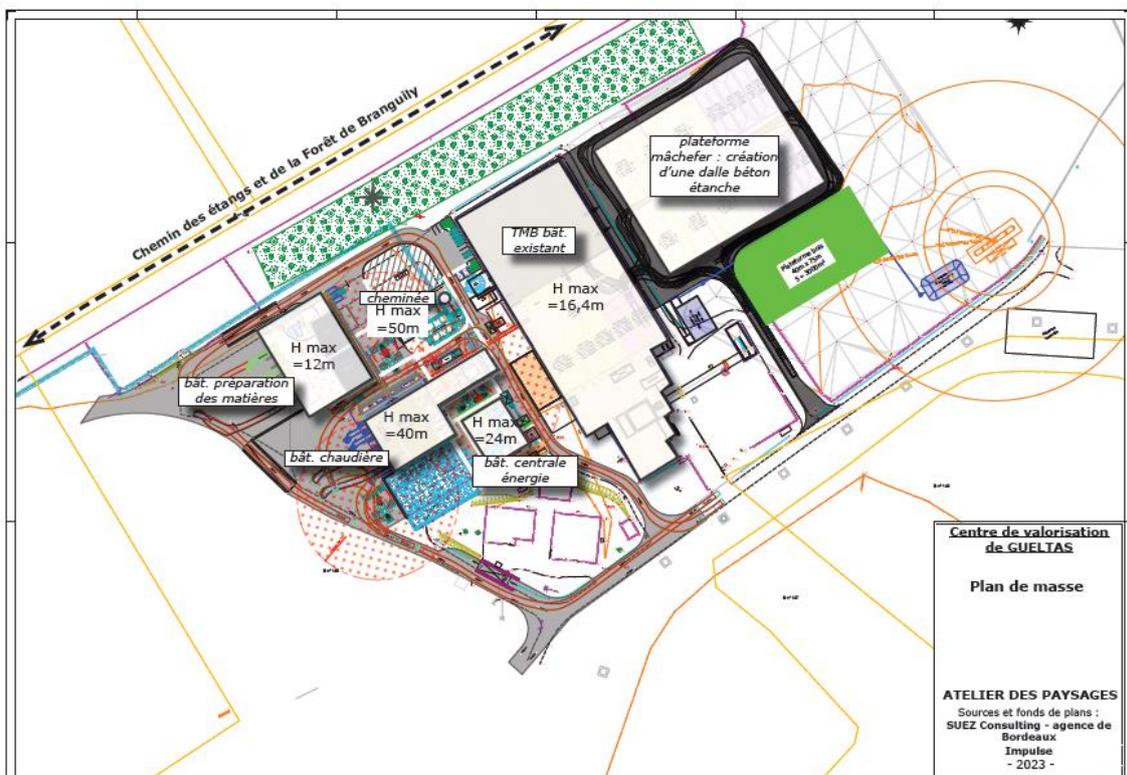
Plan des installations projetées de la plateforme de valorisation
